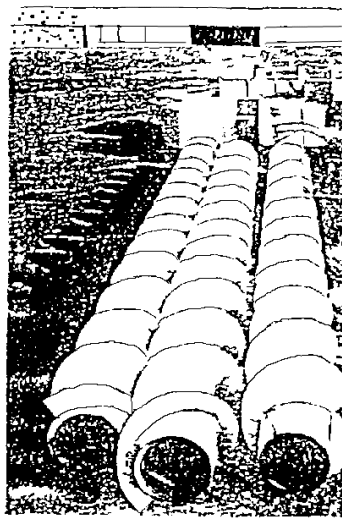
Загальний вид пустотілих шнеків бурових установок для влаштування буронабивних паль в обмежених умовах міської забудови
